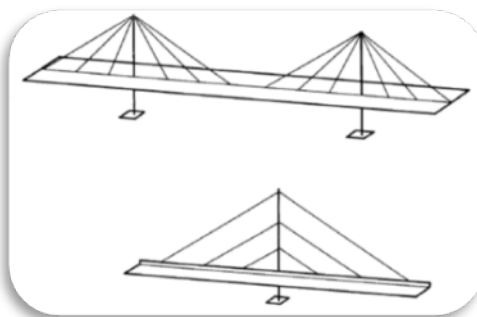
Arreglo espacial de cables con 1 plano vertical centrado o no centrado.
